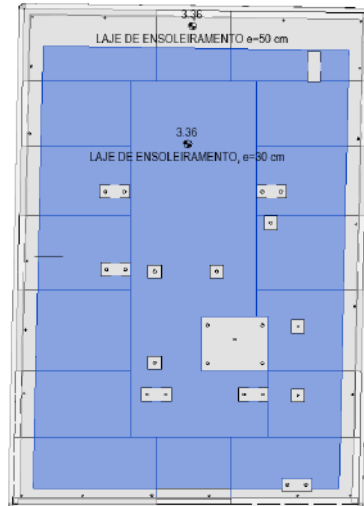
Vista em planta da laje de ensoleiramento geral e das microestacas.
